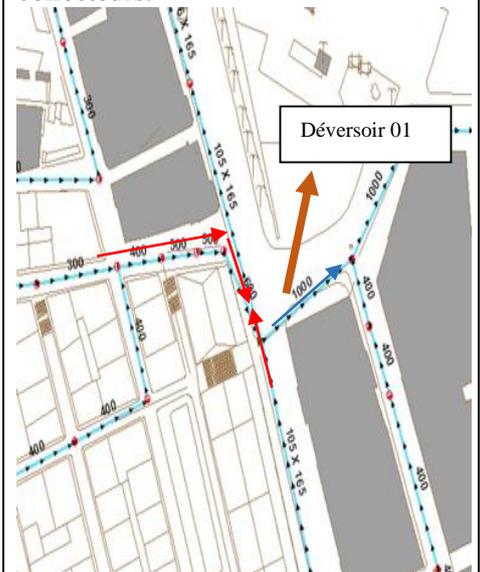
Localisation du collecteur par rapport à la chaussée/au trottoir.
